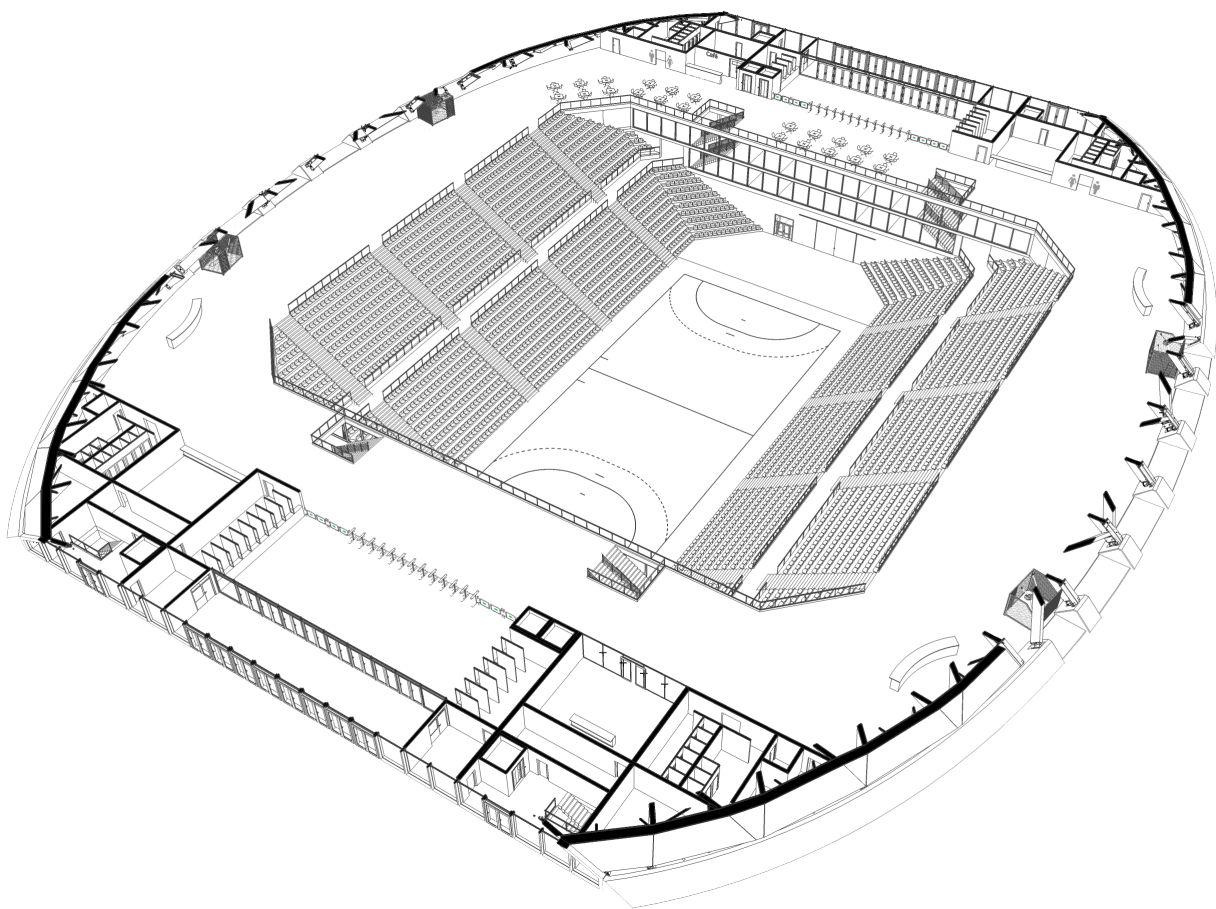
Grafik Dachdraufsicht 3D
